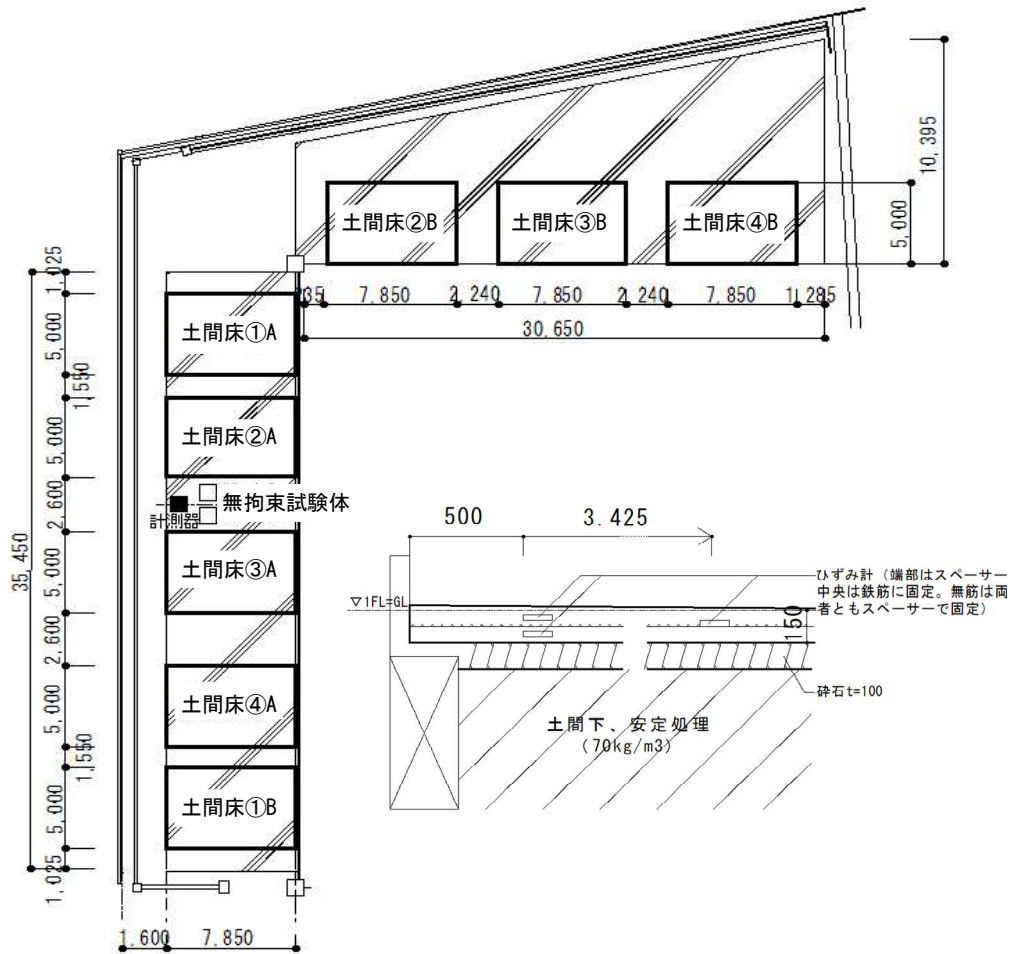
土間床の配置図およびひずみ計の床断面埋込み図
